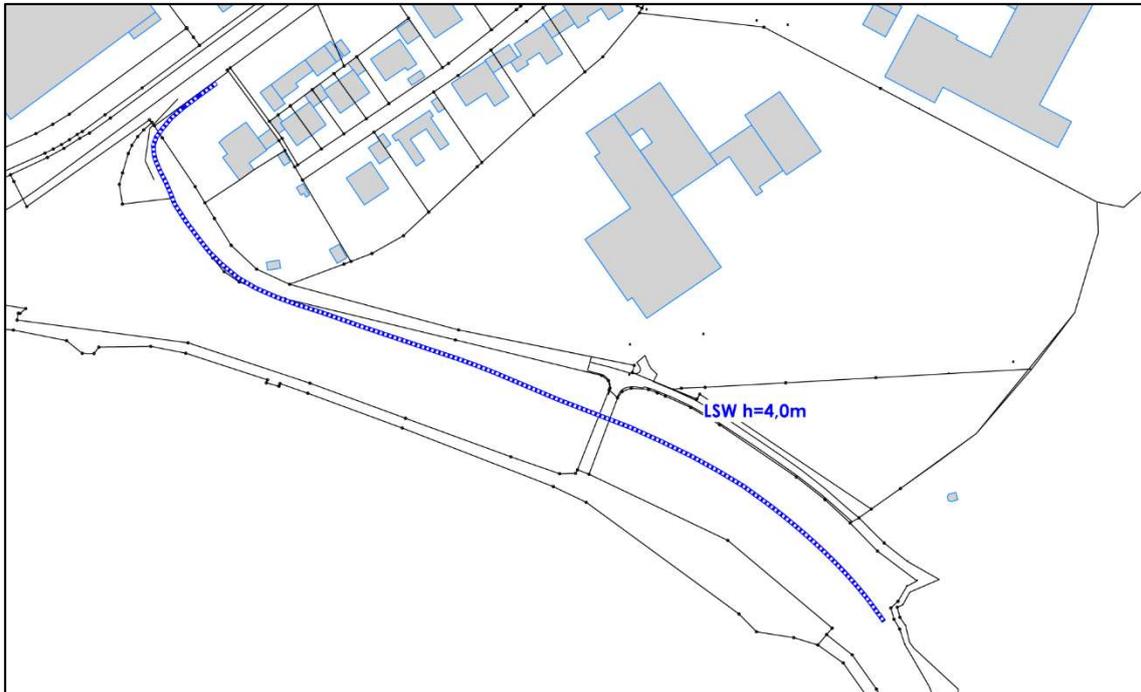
Lageplan mit Darstellung der Lärmschutzwand
